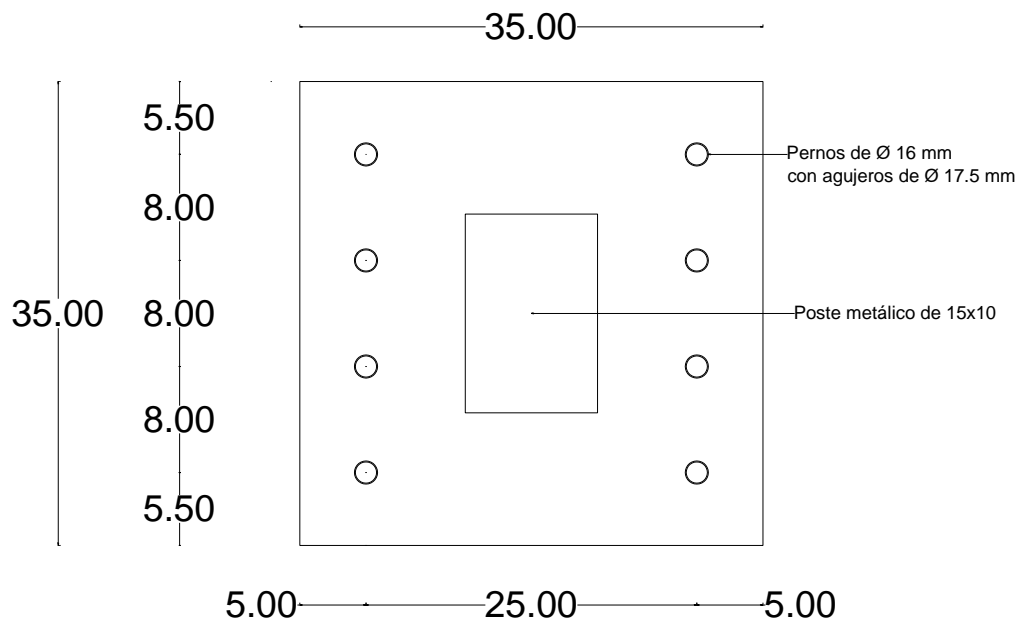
Detalle de placa base y distribución de pernos de anclaje, en centímetros. Elaborado por: Autores.
